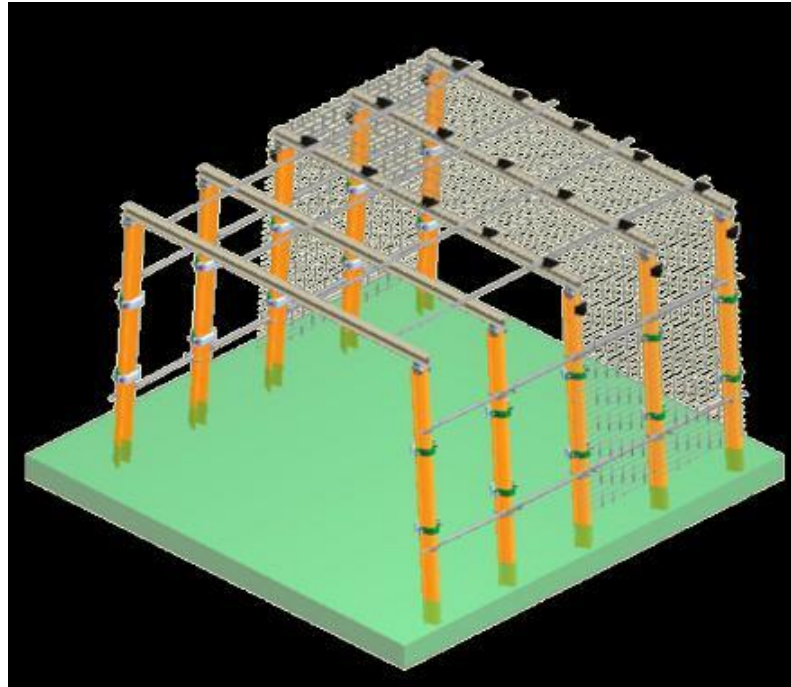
Altyapı Tesis - 3 Bölgesi
